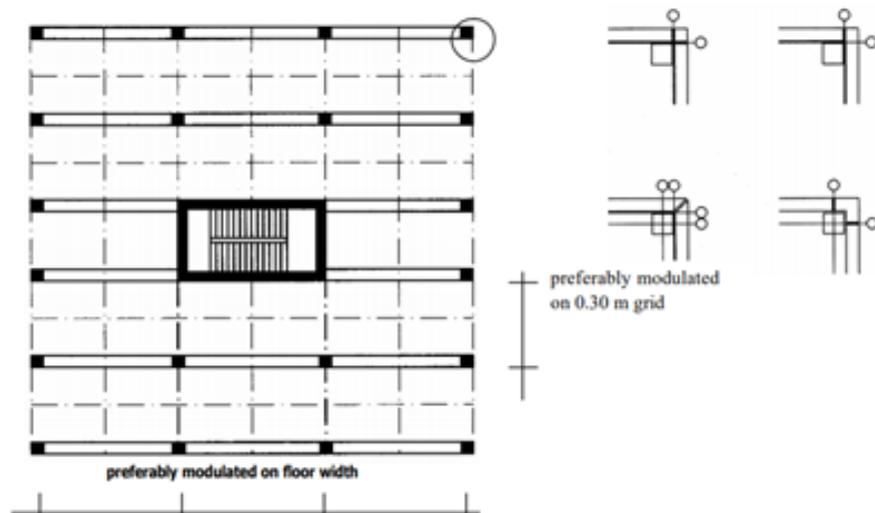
Exemplo de Layout Modular para Estruturas Pré-Moldadas
